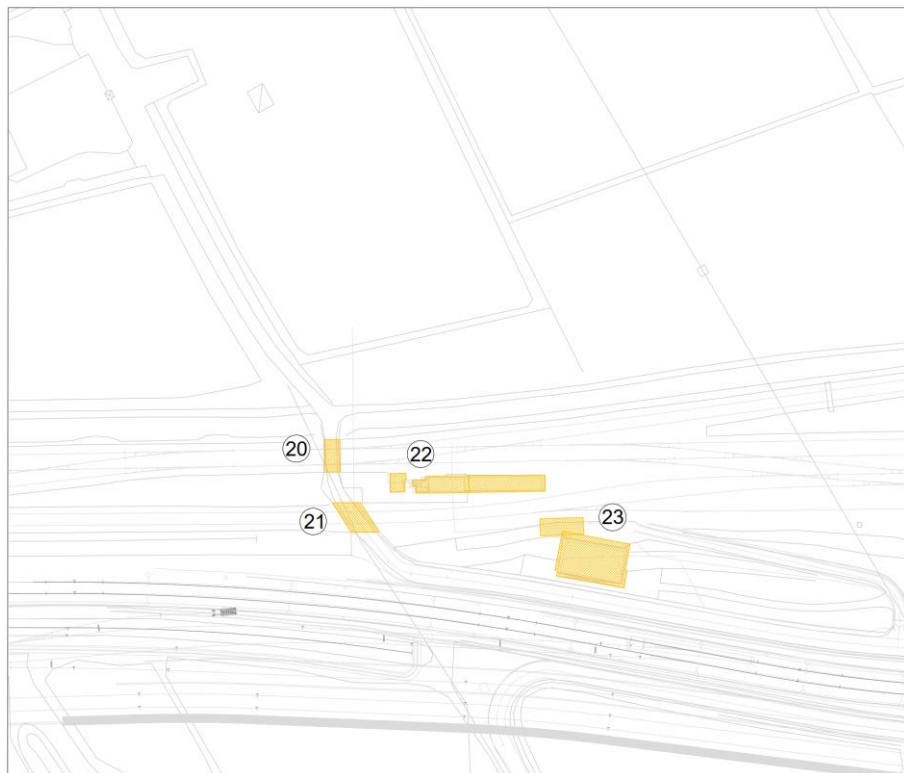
Stralcio planimetrico zona tra Via Carnia a nord e Via Fenilon a sud
